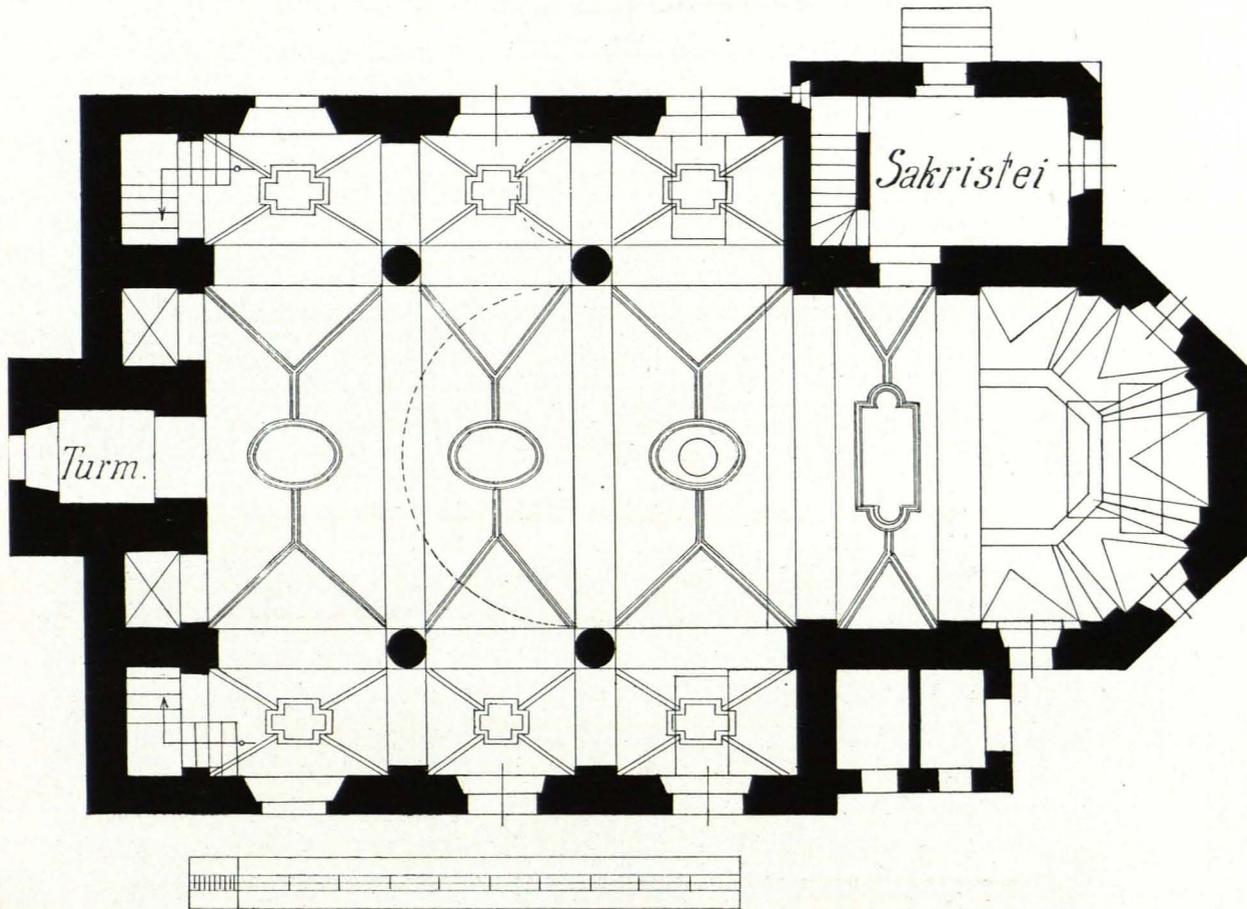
Morzg. Pfarrkirche. Grundriß 1 : 150 (S. 392)
